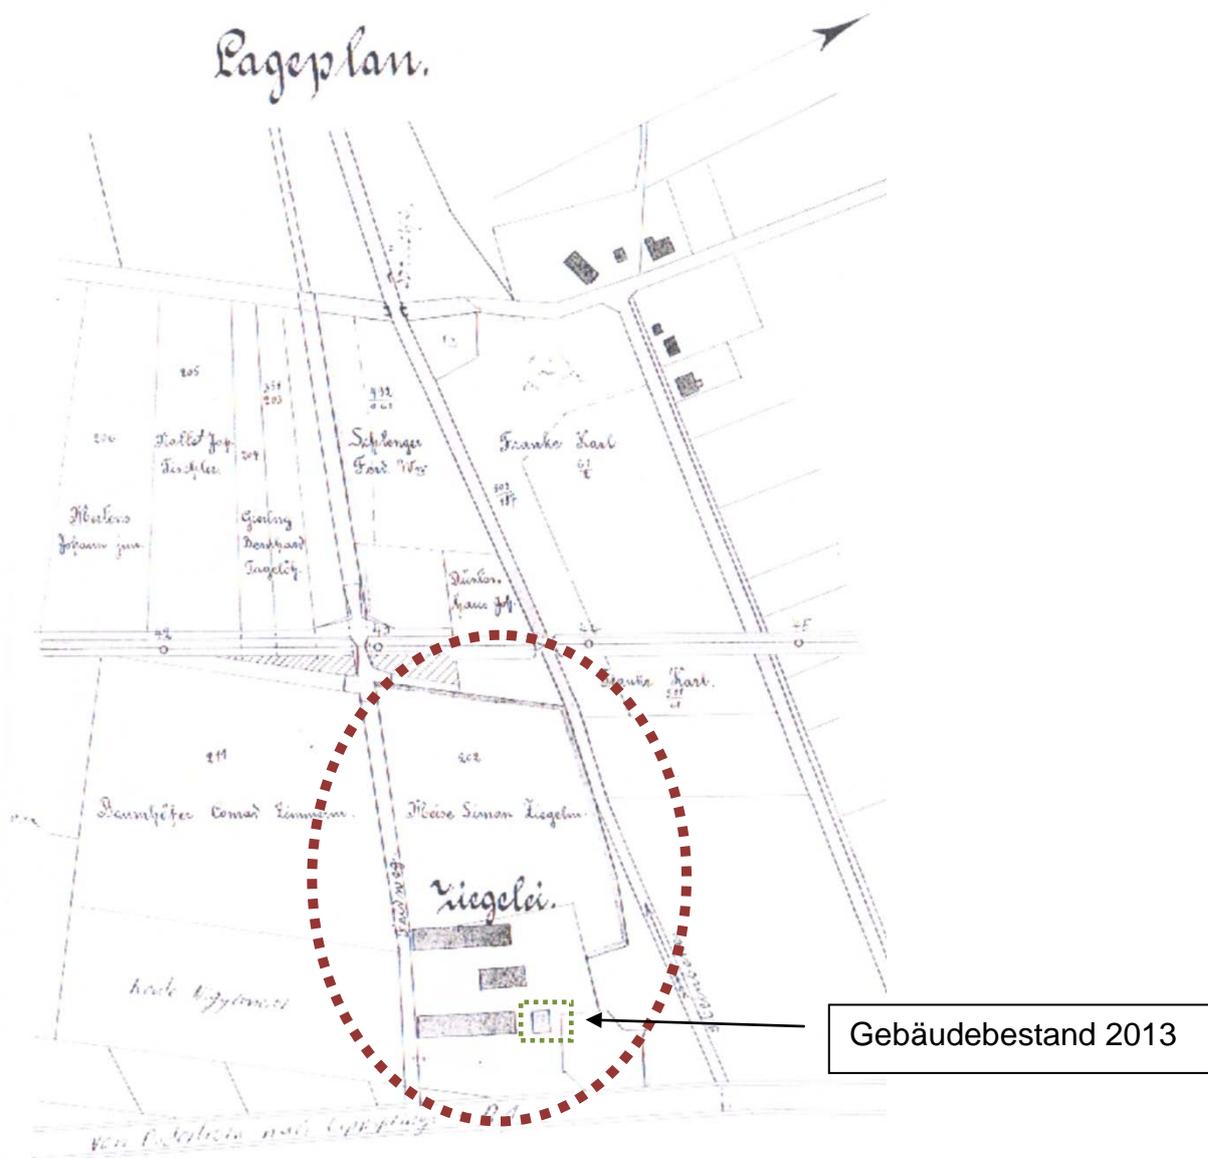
Lageplan „Neubau einer Brücke“ von 1906
